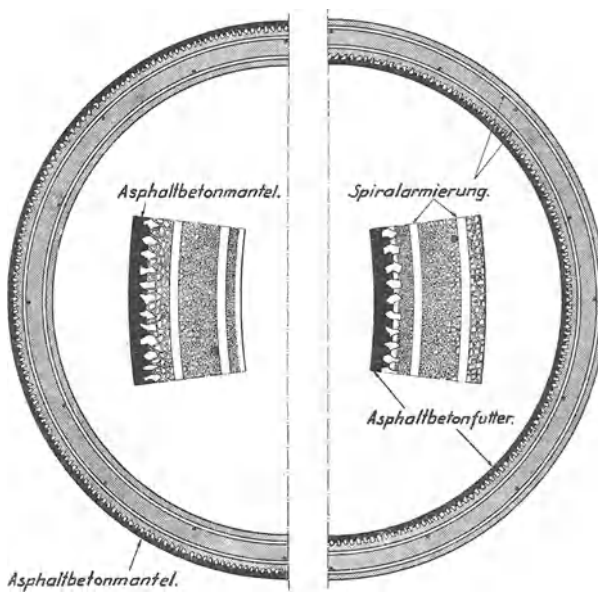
Betonrohre mit Asphaltbetonmantel.
